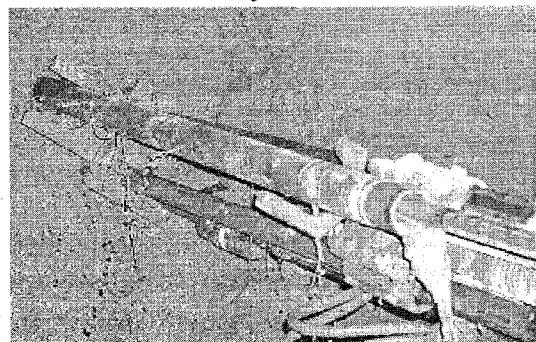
GFRP 管ボルト (巻付け成形タイプ)
